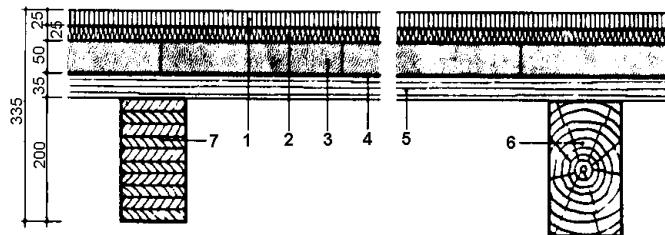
Деревянные балочные перекрытия. Вариант III.
